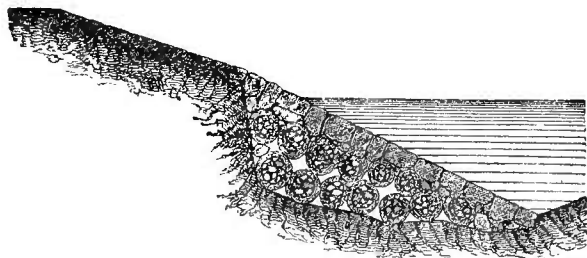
Fascinage de berge avec revêtement complet en pierres.
